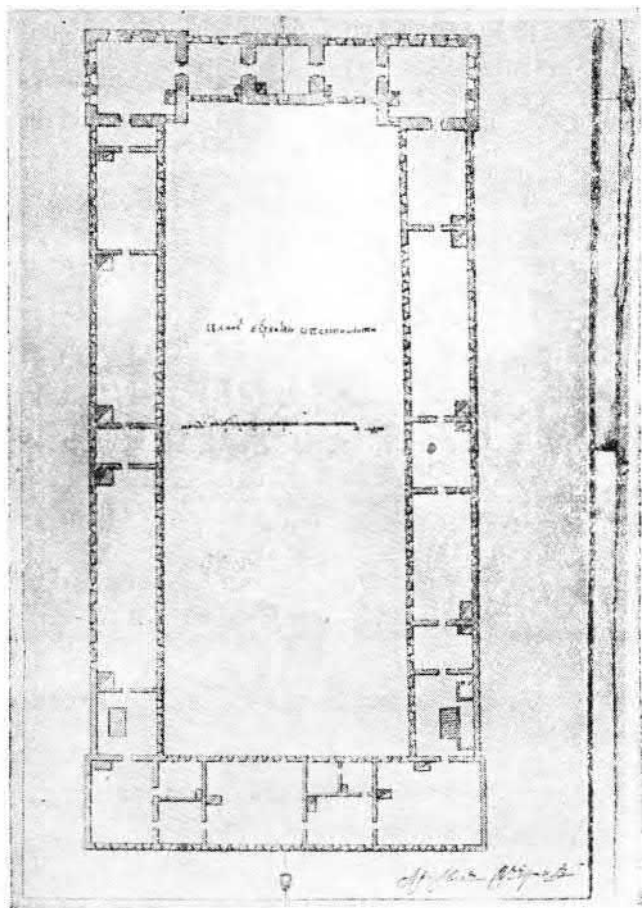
Большой суконный двор. План 2-го этажа (ЦГАДА).
